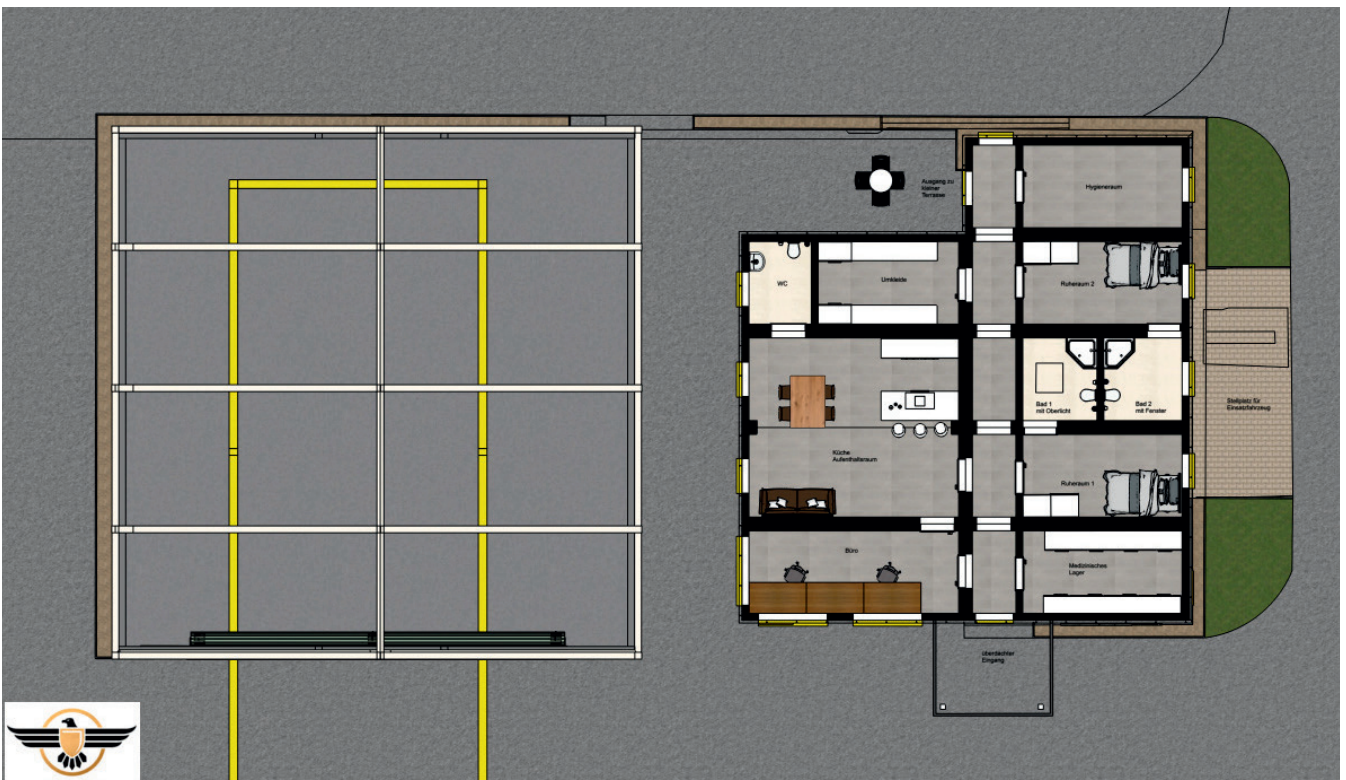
Beispiel einer Containerstation als flexible Lösung einer Multikopterstation (Grundriss)
